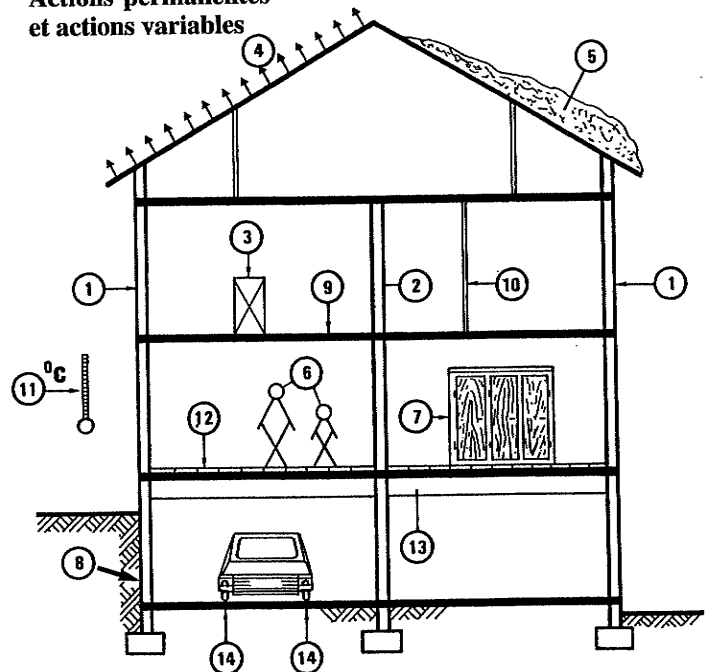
Coupe schématique d'un bâtiment à 4 niveaux.
